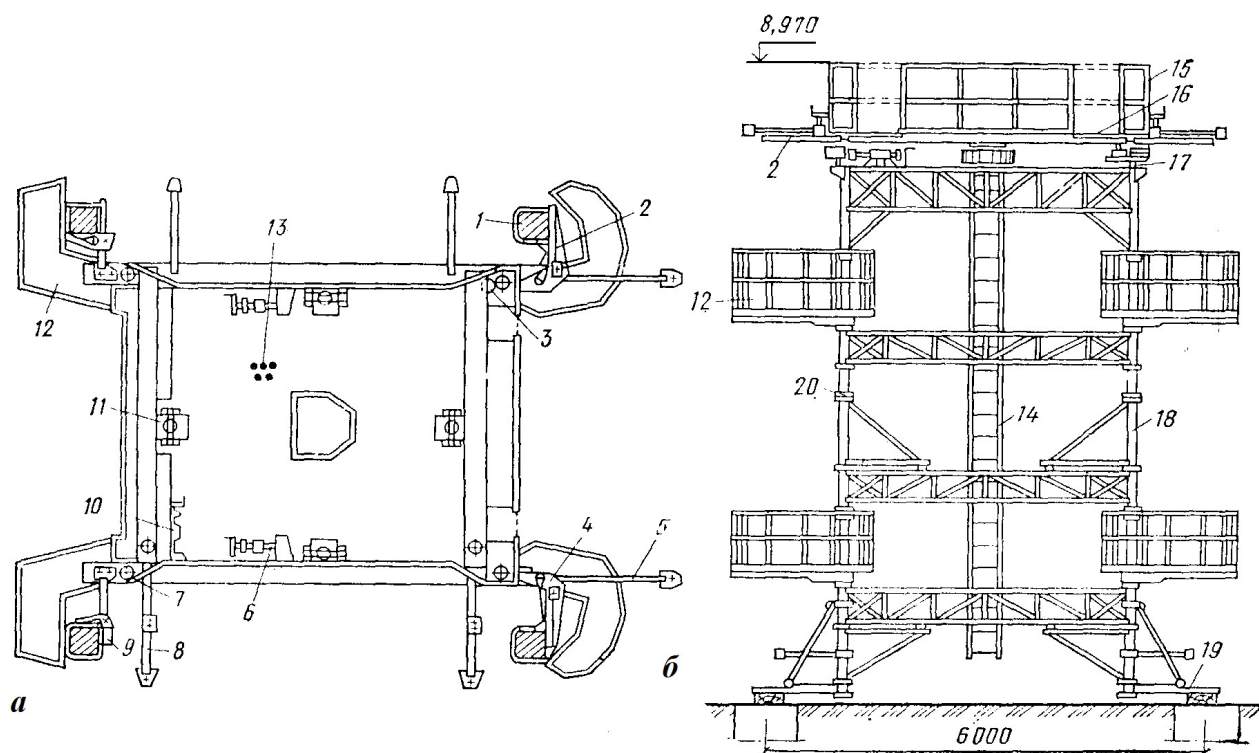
Рамно-шарнірний індикатор (РШ): а - план; б - вид збоку; 1 - монтована колона; 2 - канат для закріплення колон; 3 - шарнір; 4 - хомут поворотний; 5 - поздовжня тяга; 6 - вузол поздовжнього переміщення; 7 - натяжний пристрій хомута; 8 - тяга поперечна; 9 - рухомий упор сходів; 10 - вузол поперечного переміщення; 11 - гальмові вузли кріплення рами; 12 - поворотна коліска; 13 - настил; 14 - сходи; 15 - огороження; 16 - плаваюча рама; 17 - кулькові опори; 18 - стояки риштування; 19 - опорна лапа; 20 - фланцевий стик
